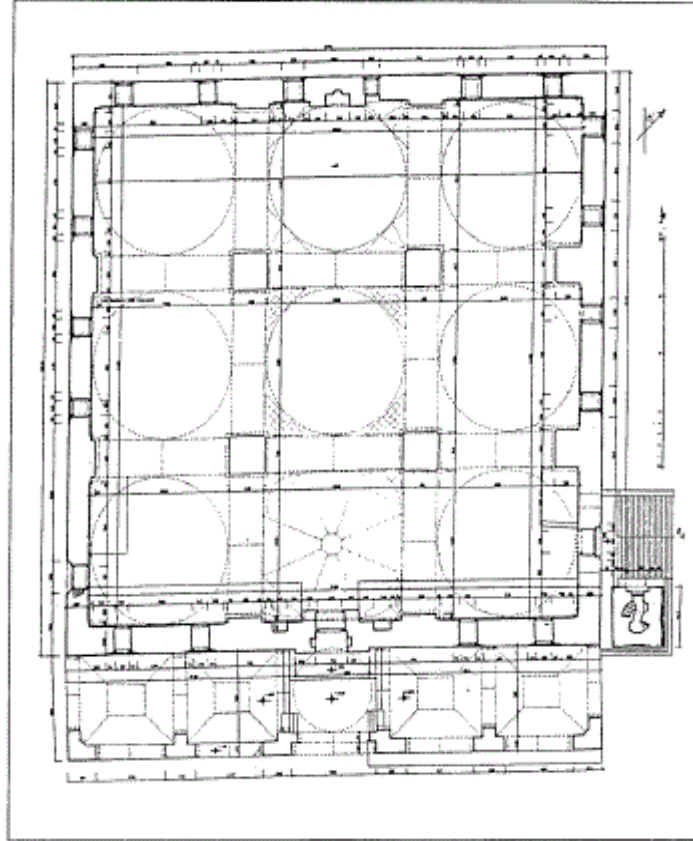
مسقط أفقي لمسجد روم محمد باشا في اسكندار باستانبول (عن : جودوين).
